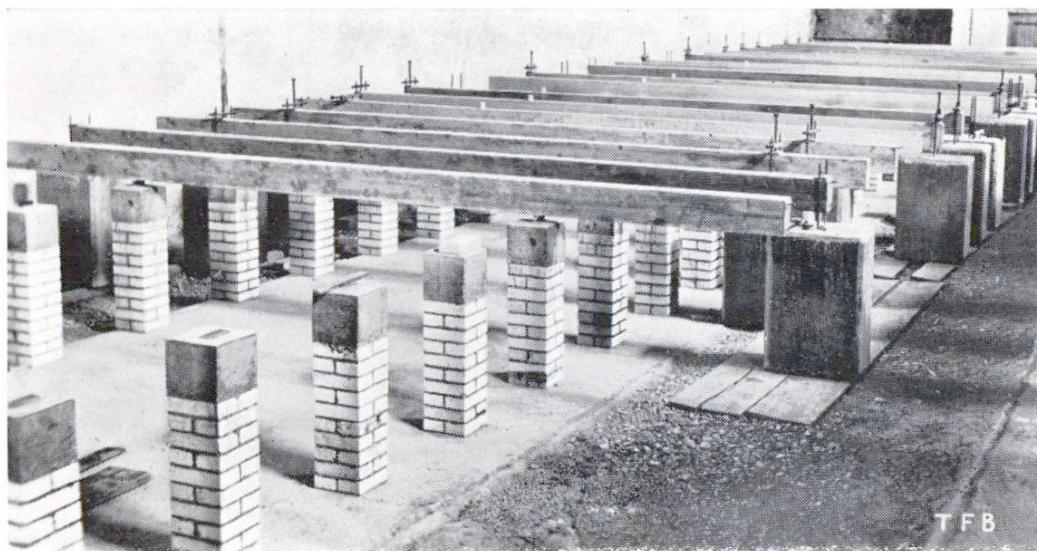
Probekörper aus vorgespanntem Eisenbeton. Versuchsanlage in Schinznach-Bad der SIA-Kommission für vorgespannten Eisenbeton
